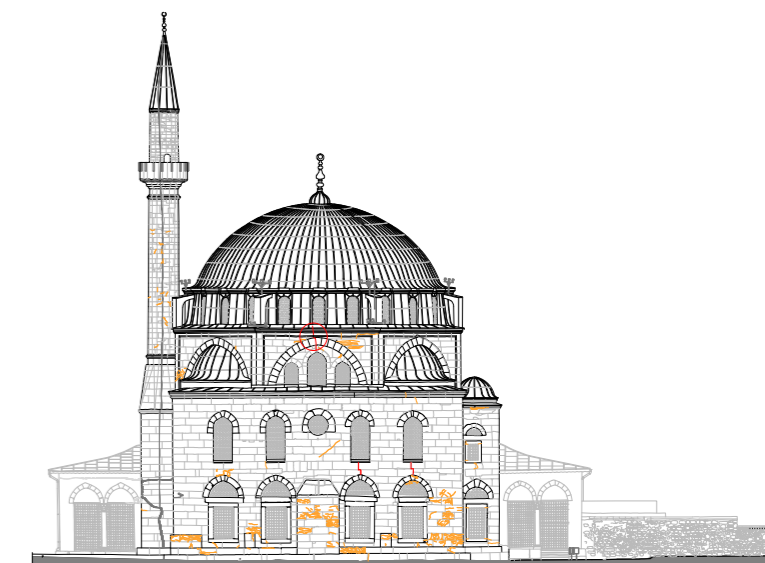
uadro fessurativo prospetto Sud est.pdf
